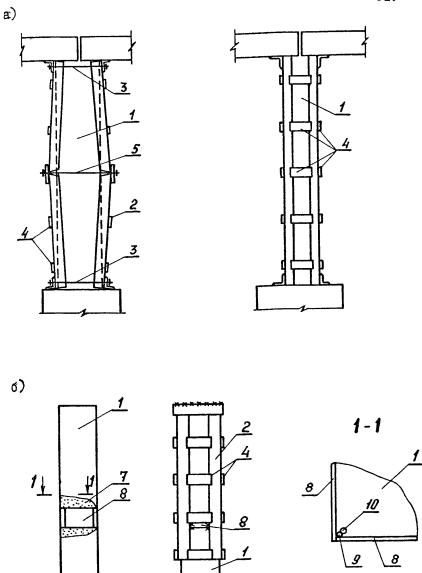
Усиление железобетонных колонн стальной обоймой
